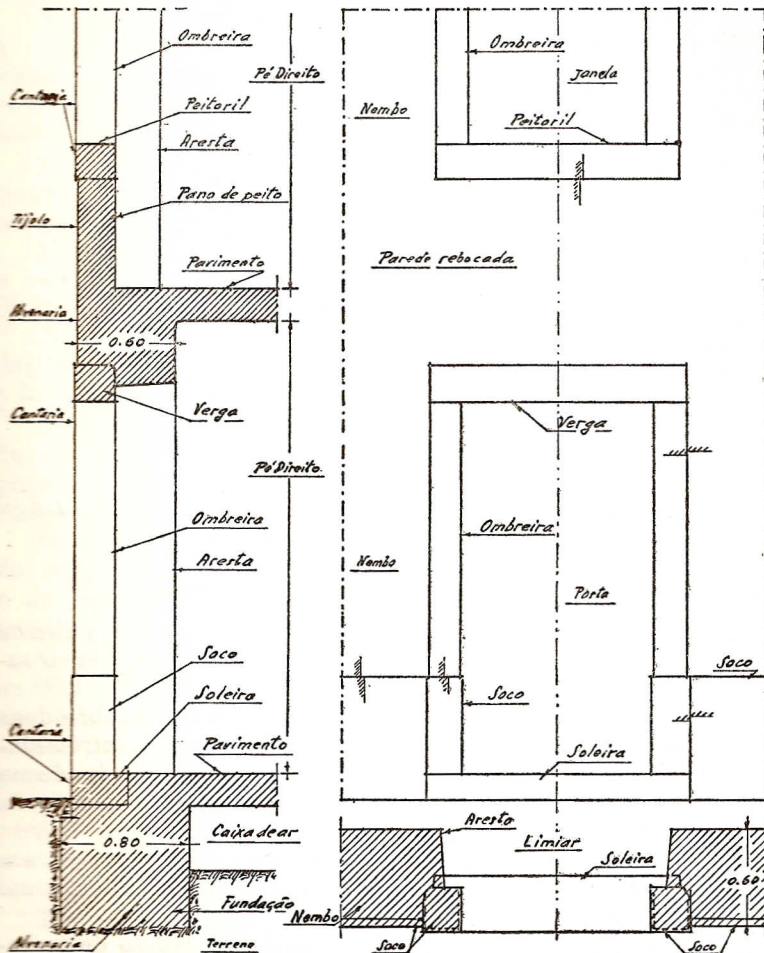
CORTE DE UMA FACHADA DESDE AS FUNDAÇÕES
